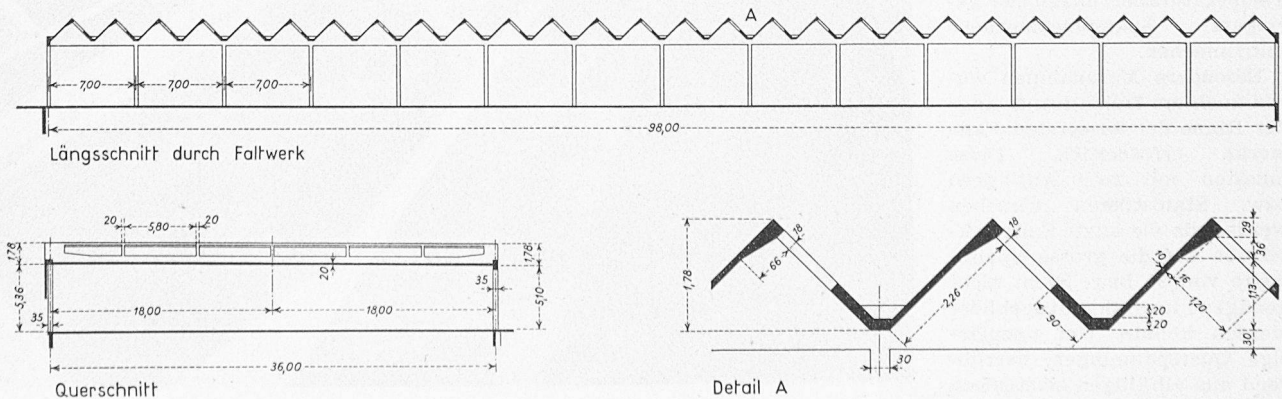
Längs- und Querschnitt 1:600, Detailschnitt 1:120
